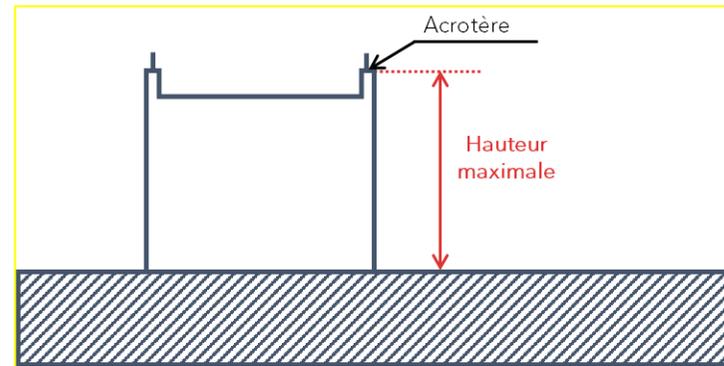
Cas d'une construction avec une toiture terrasse / plate
